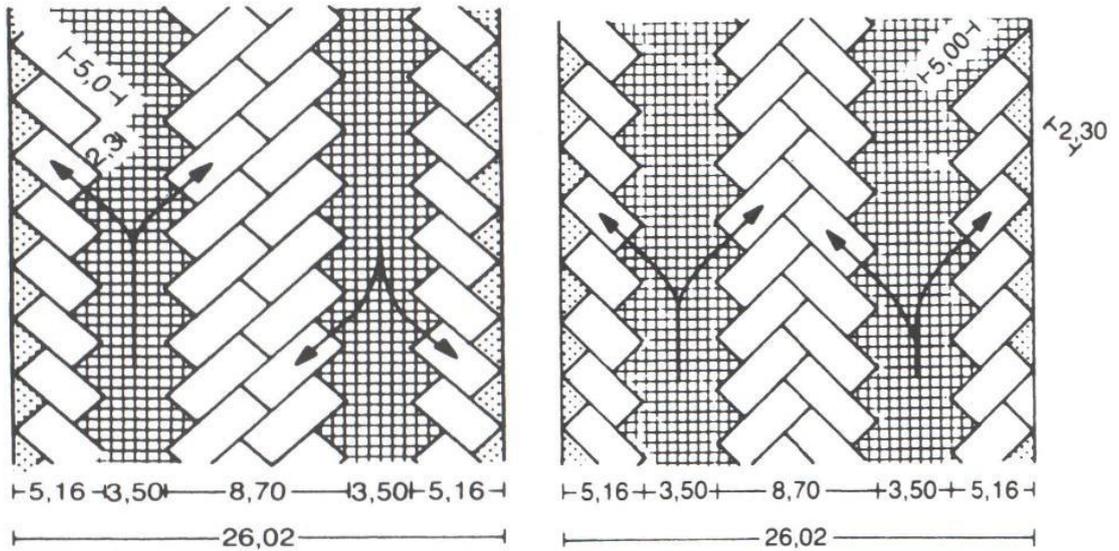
Конструктивные размеры при косоугольной парковке машин и схема движения;
